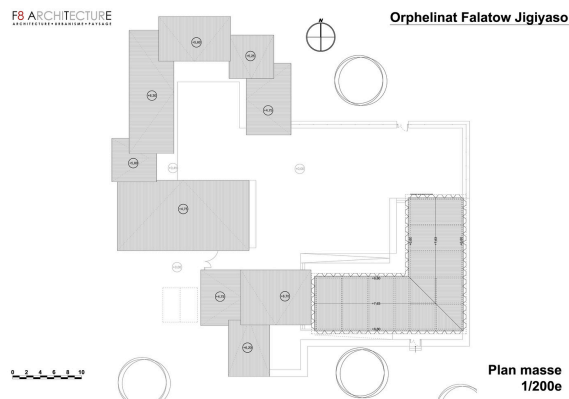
Planta de Techos - Orfanato Falatow Jigiya
